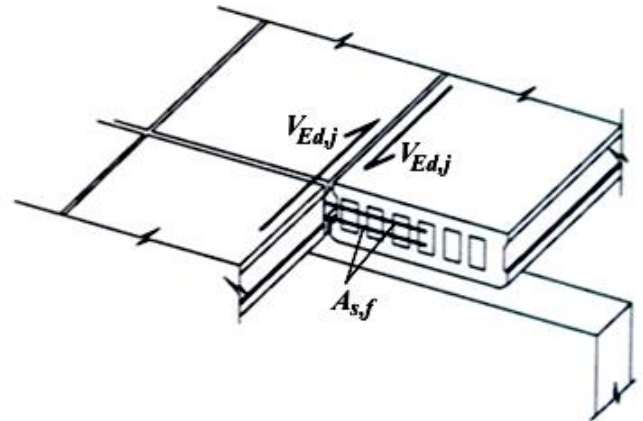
Расположение арматуры в швах между плитами пустотного настила [1]
